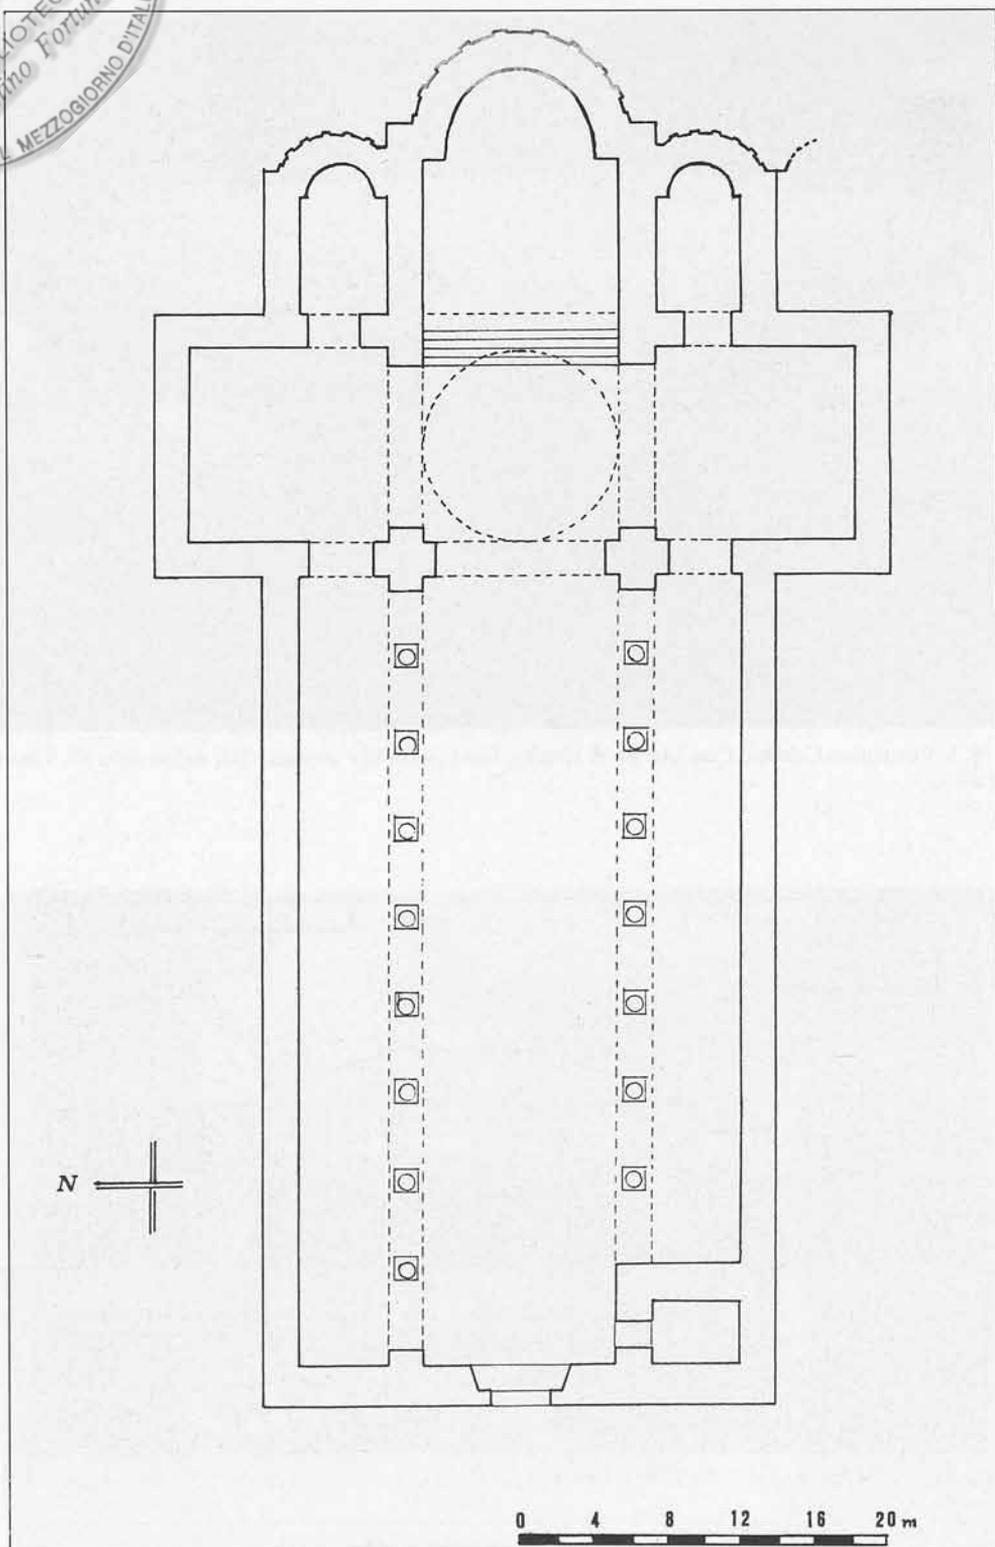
Mileto, SS. Trinità. Saggio di restituzione grafica dell'impianto planimetrico.
